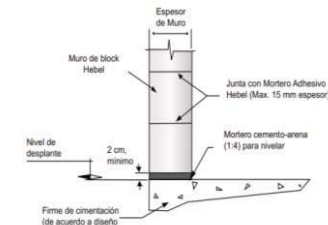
Detalle de muro Hebel. Fuente: www.hebel.mx
